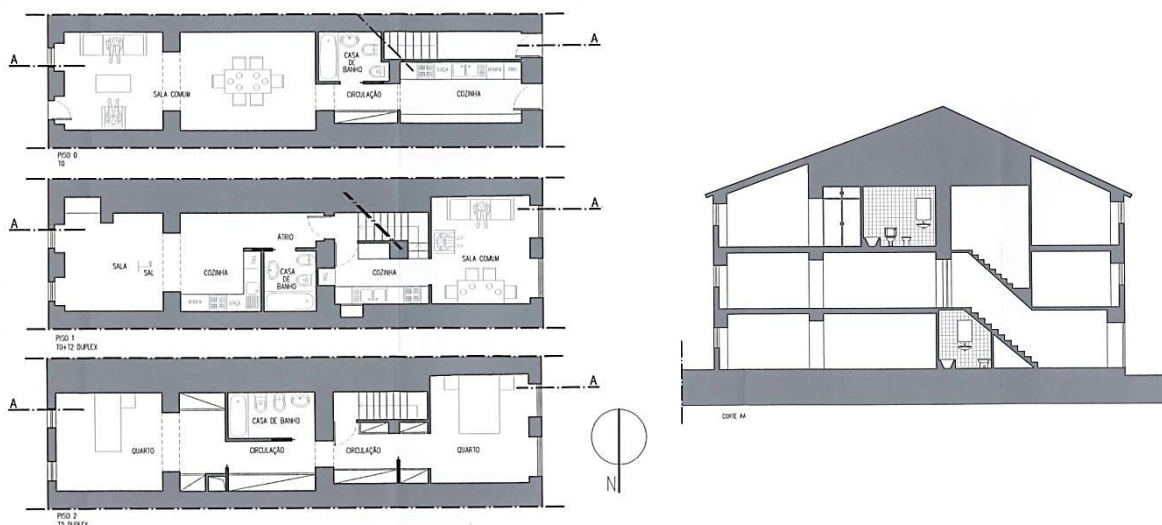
Desenhos técnicos (solução 2 - proposta) - plantas/corte
